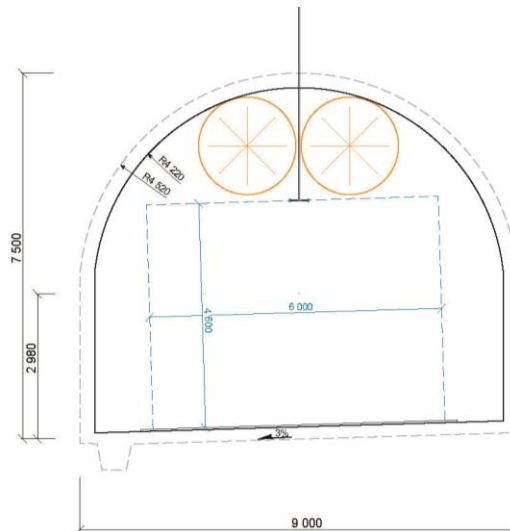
Forslag til tverrsnitt for TBM-tunneler med betongelementer.
